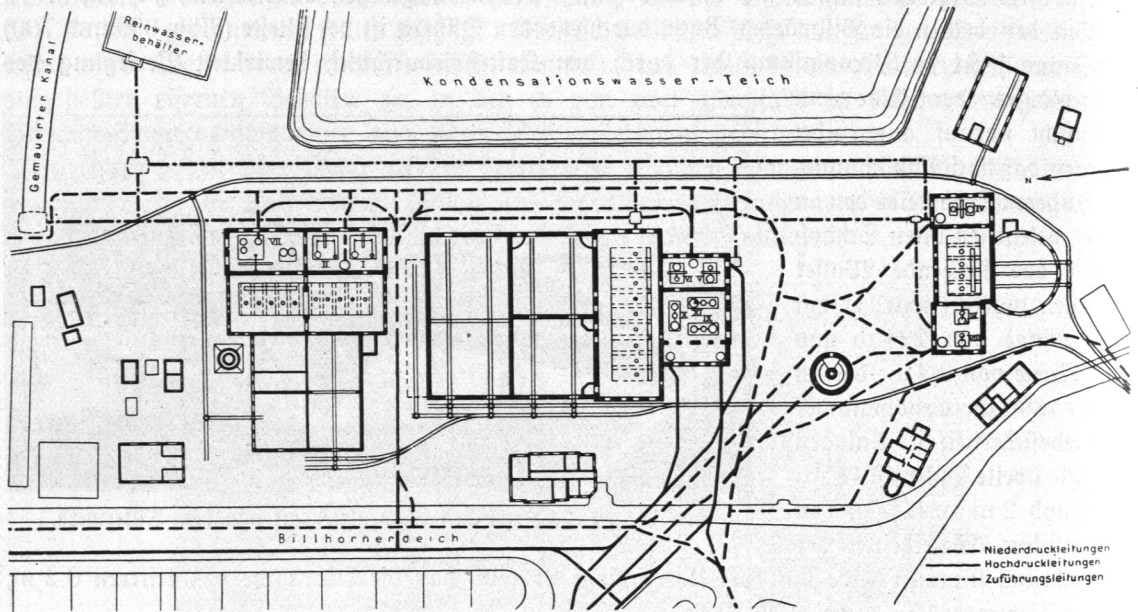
Lageplan des Pumpwerks Rothenburgsort.
